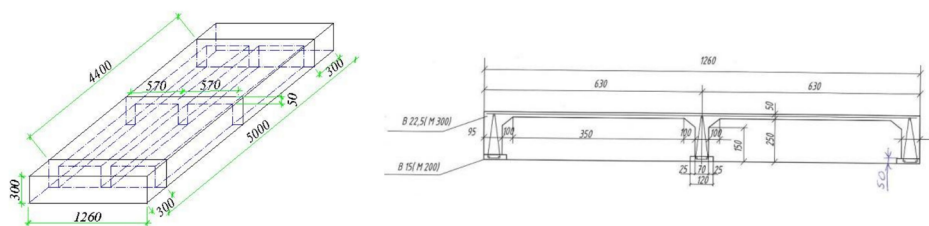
Схема фрагмента часторебристого перекрытия со сборно-моноклитными элементами
